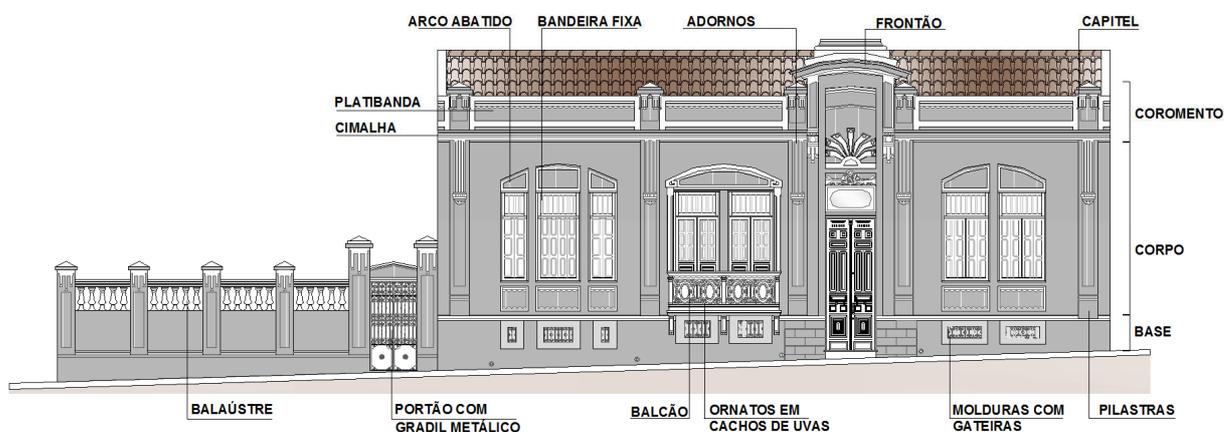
Graficação digital – Fachada Edificação Rua Pinheiro Machado, n° 1984
